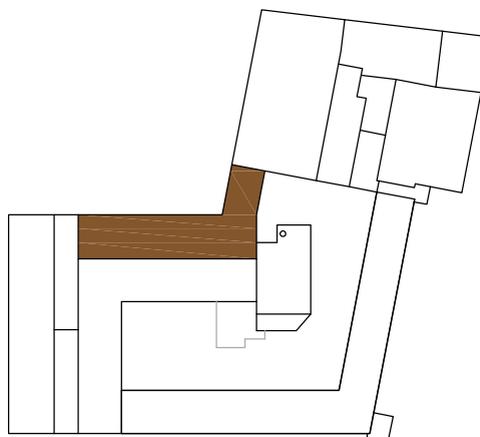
Grundriss für einen Zubau zum Kesselhaus, 1965
